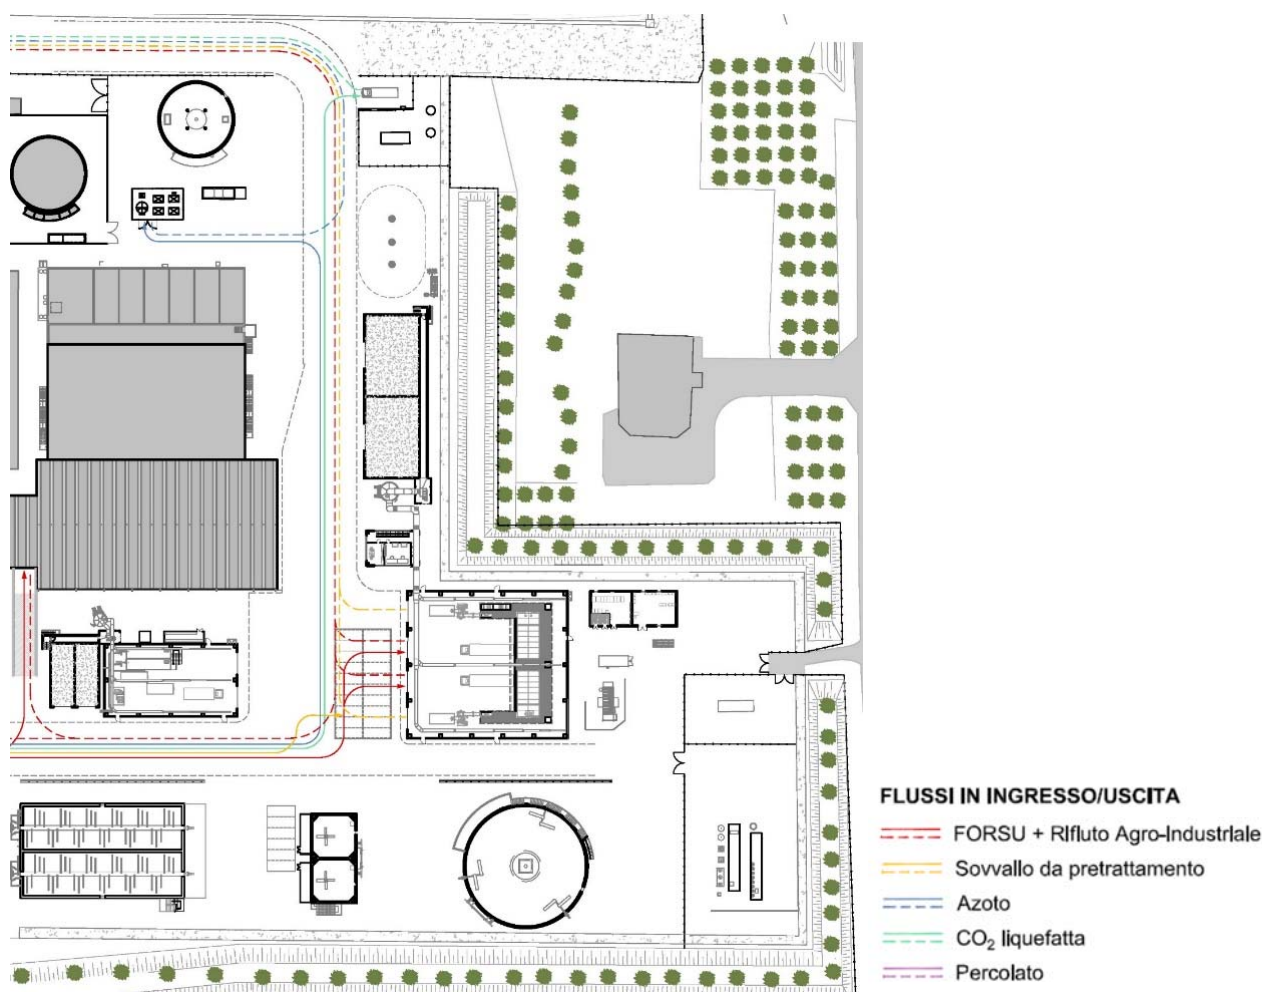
Estratto Planimetria con indicazione della viabilità interna all'impianto [TEC_006]
